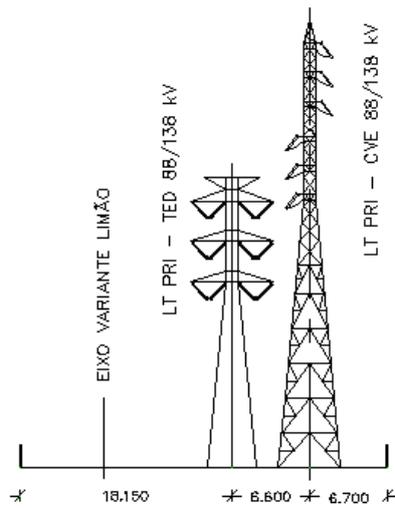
Trecho RAE LAPA - ETD LIMÃO (implantação de variante)
